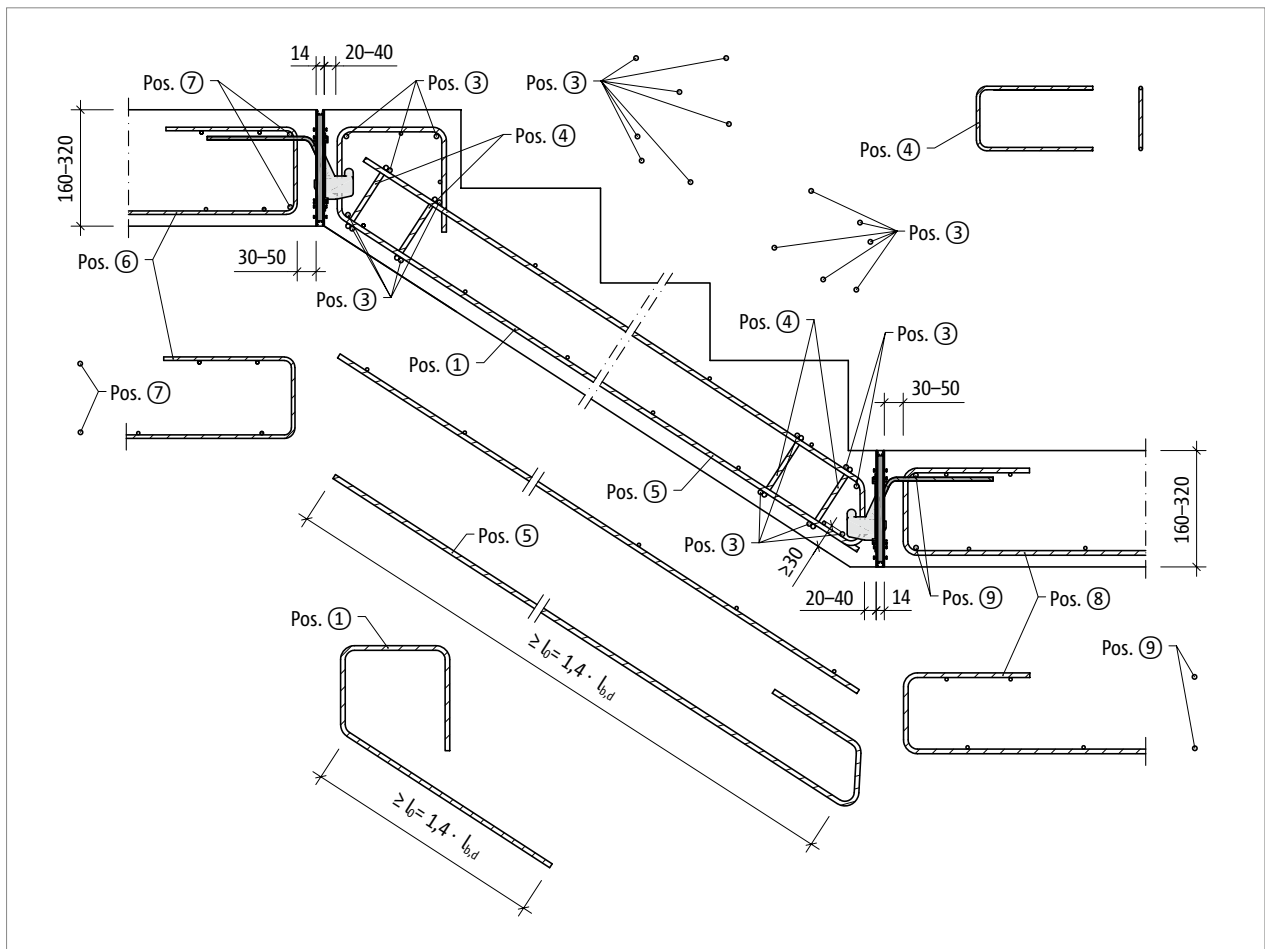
Tronsole® T: Bauseitige Bewehrung
